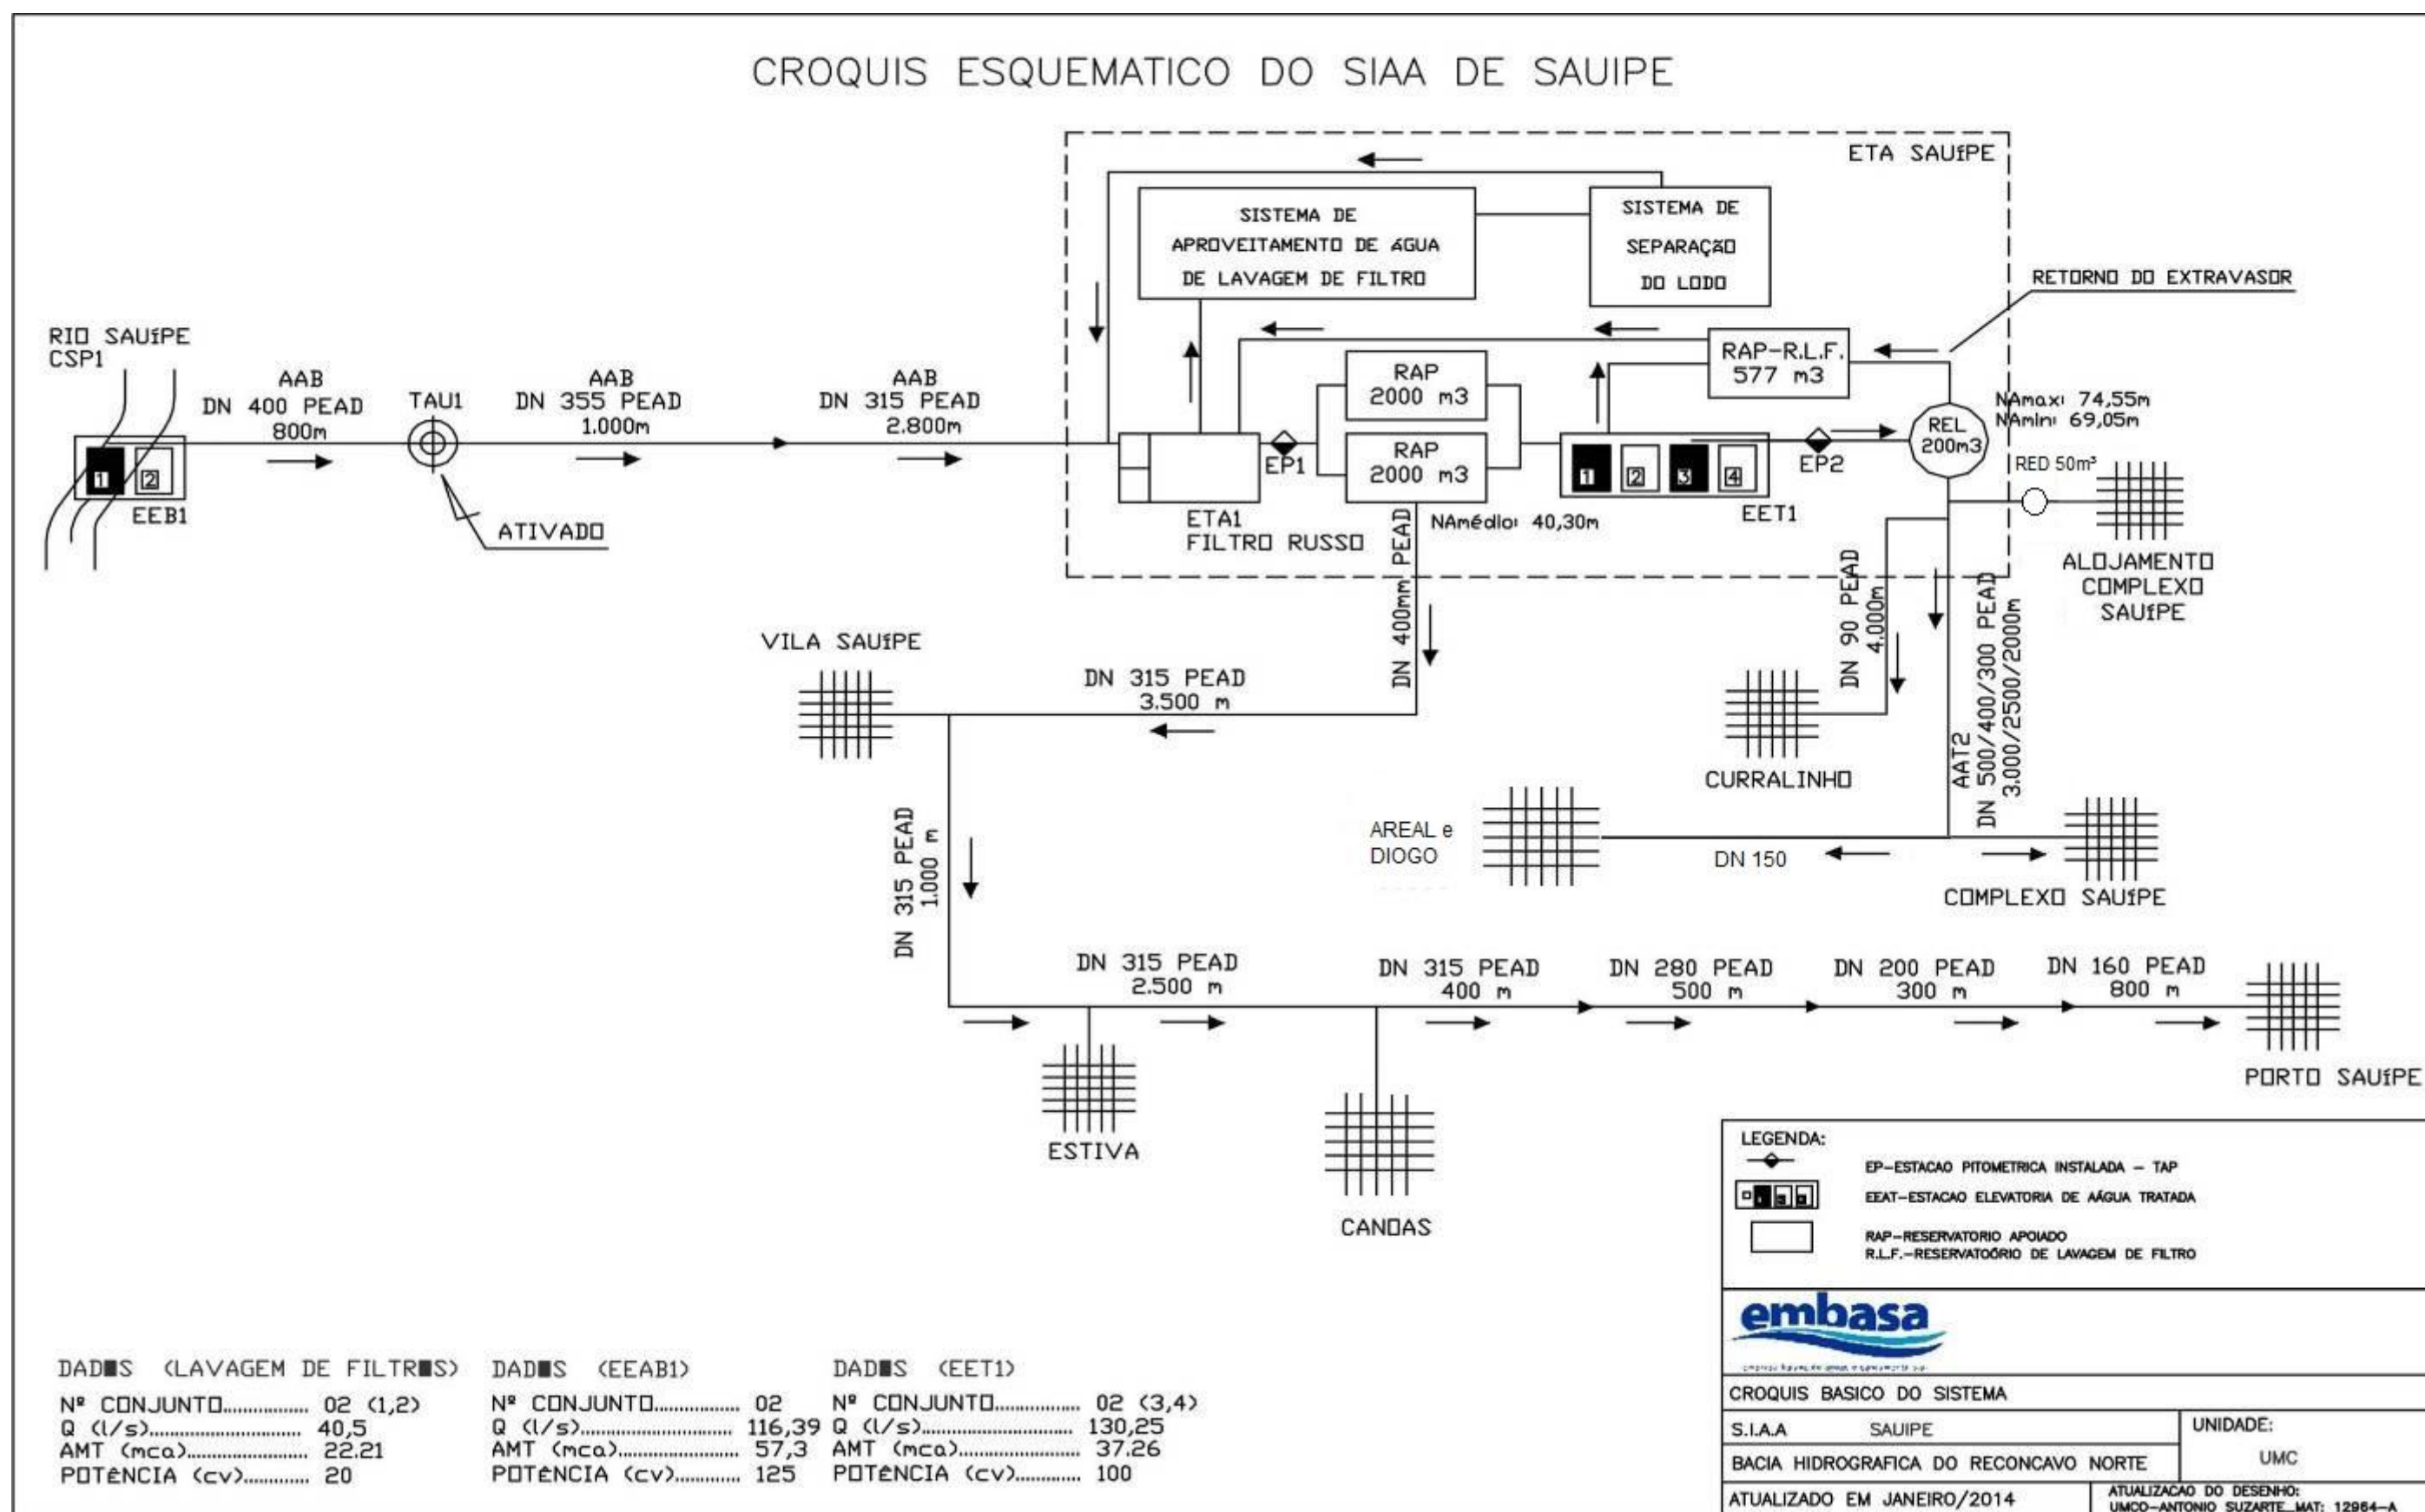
Croquis Esquemático do SIAA de Saúipe
